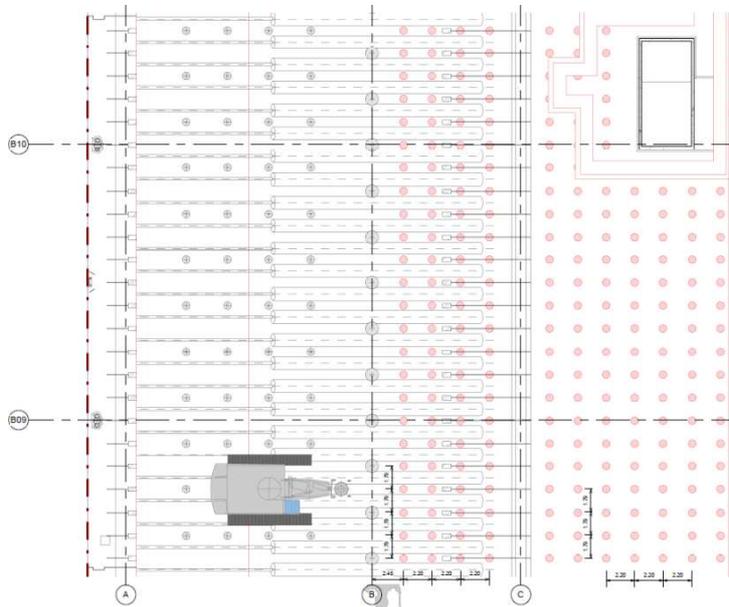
Planimetria con indicazione della posizione delle colonne in ghiaia
